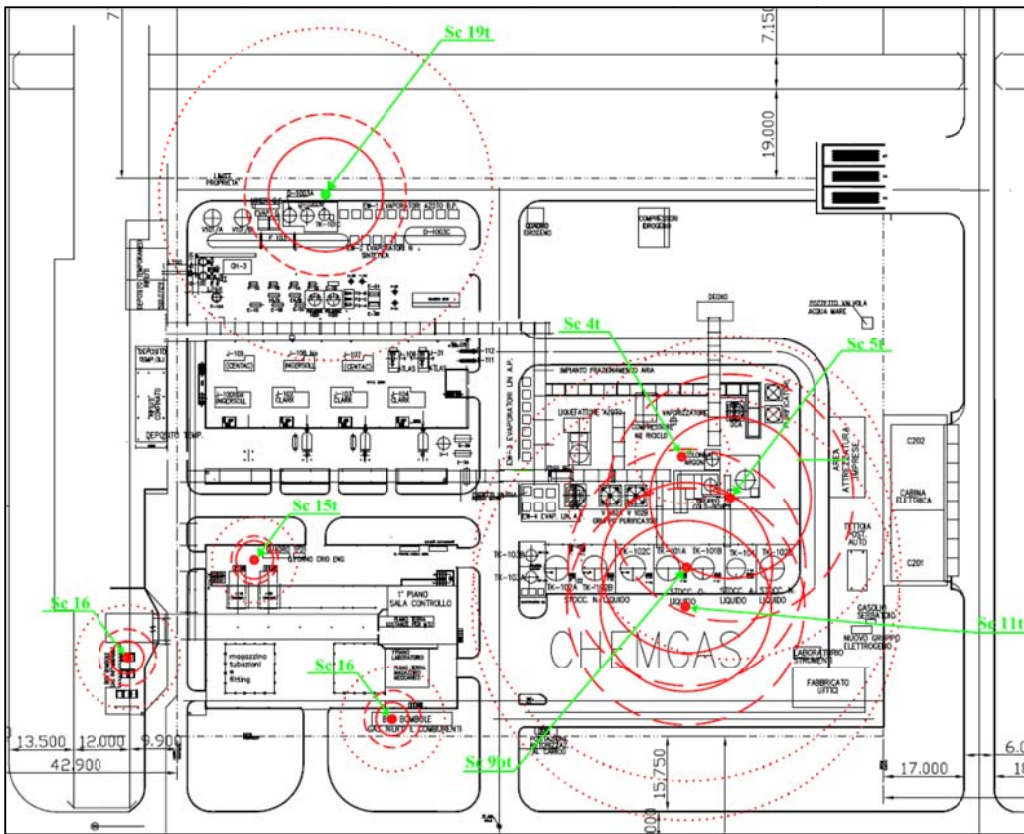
Stralcio della Planimetria limiti proprietà impianto – Dispersioni Ossigeno Rottura Totale D5
